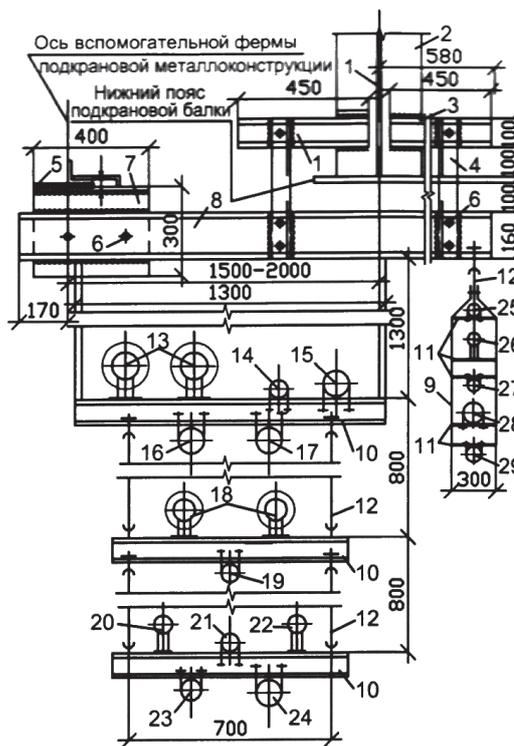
Прокладка коммуникаций на подвесках к швеллеру, крепящемуся к ребрам жесткости подкрановой балки и вспомогательной ферме подкрановой металлоконструкции: 1 – подкрановая балка (ПБ); 2 – ребро жесткости ПБ; 3 – швеллер № 10; 4 – уголок 63х63х6; 5 – лист 200х200х10; 6 – монтажные болты; 7 – лист 400х300х8; 8 – несущий швеллер № 16; 9 – подвесная «корзинка»; 10, 11 – подопорные швеллеры и уголки; 12 – шарнирные тяги подвесок; трубопроводы: 13 – теплоснабжения (прямой и обратный) $2 \times \varnothing$ 125, 130/70 °С, 0,8/0,4 МПа; 14 – газопровод \varnothing 80 низкого давления – 0,008 МПа; 15 – то же, \varnothing 100 высокого давления – 0,6 МПа; 16 – осушенного сжатого воздуха (СВ) \varnothing 150 – 0,7 МПа (технологический); 17 – СВ \varnothing 100 – 0,4 МПа; 18 – теплоснабжения $2 \times \varnothing$ 100; 19 – азота \varnothing 50 – 2 МПа; 20 – газопровод \varnothing 50 среднего давления – 0,3 МПа; 21 – сжатого воздуха \varnothing 50 – 0,6-0,7 МПа (на ремонтные нужды); 22 – кислорода \varnothing 50 – 1,6 МПа (то же); 23 – питьевой воды, \varnothing 100 – 0,4 МПа; 24 – противопожарный \varnothing 125 – 0,6 МПа; 25 – осушенного СВ \varnothing 50 – 0,5 МПа; 26 – газопровод среднего давления \varnothing 50 – 0,15 МПа; 27 – азота \varnothing 50 – 1,5 МПа; 28, 29 – воды (прямой и обратный) \varnothing 150 – 0,4 МПа
